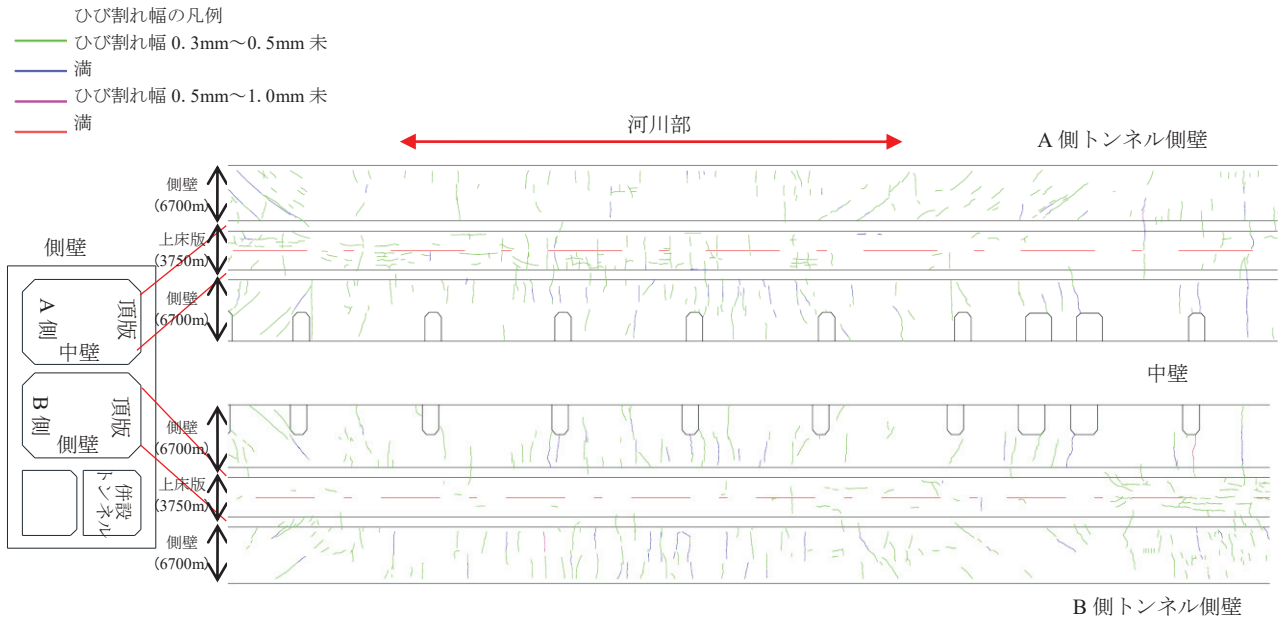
トンネル内面のひび割れ状況（調査時期：竣工時から経年 33 年）
